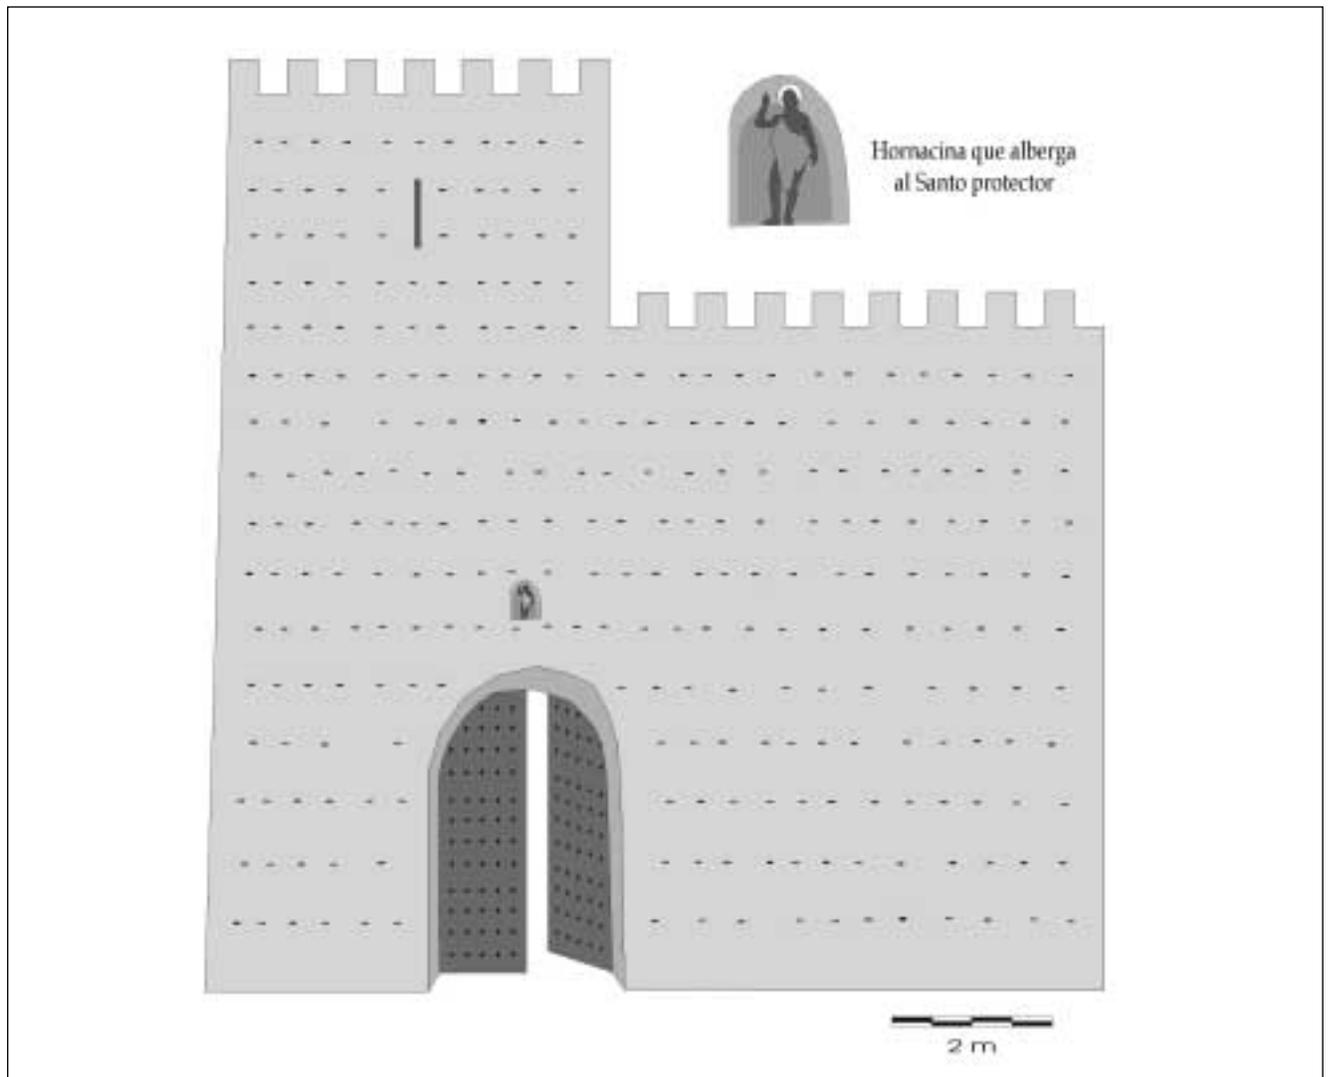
Propuesta de reconstrucción de la Torre de Gonzalo Gil, lienzo de muralla y Puerta de Caravaca.
